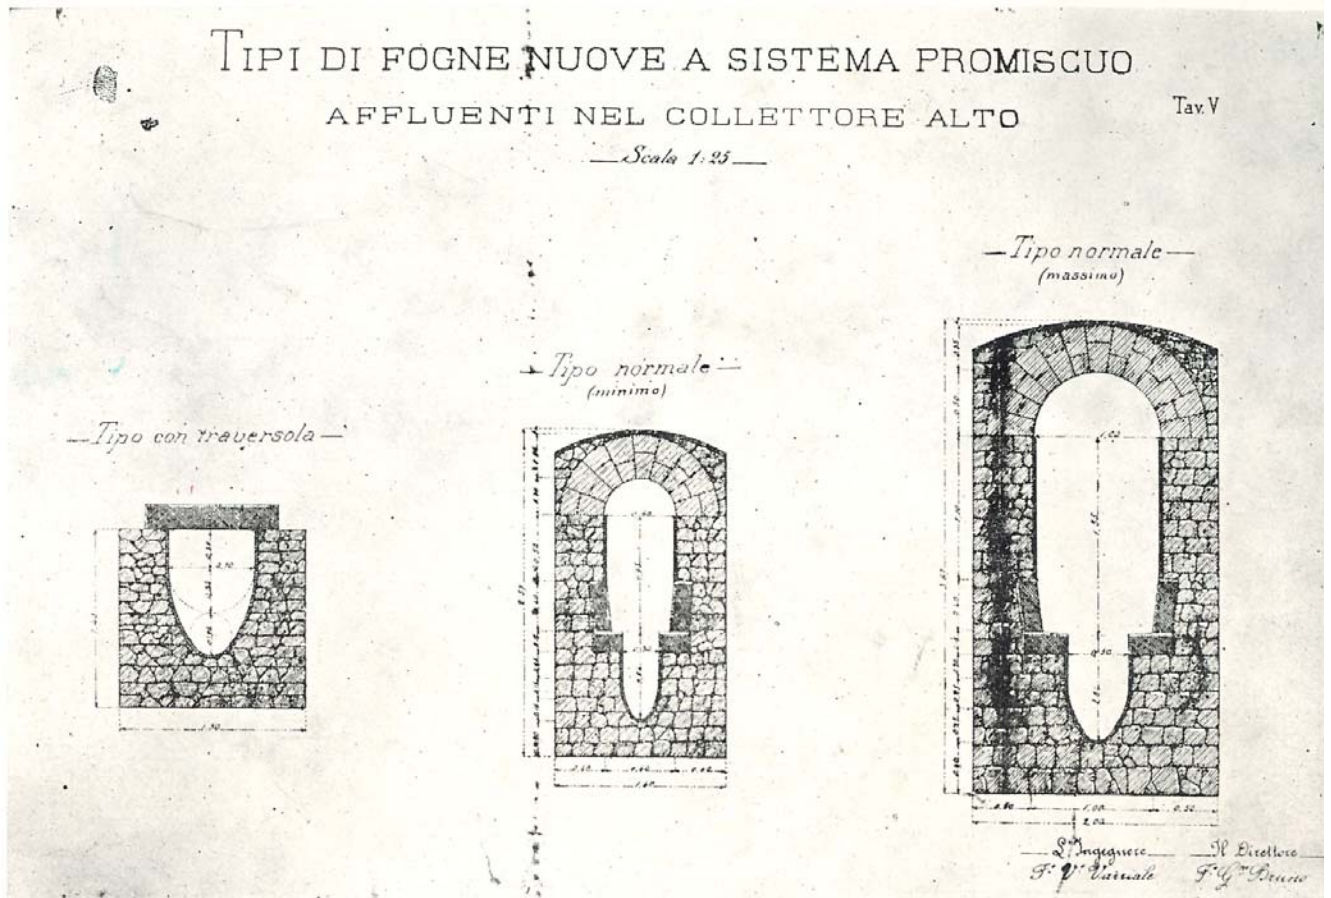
planimetria estratta da pubblicazione storica "il sottosuolo di Napoli"
